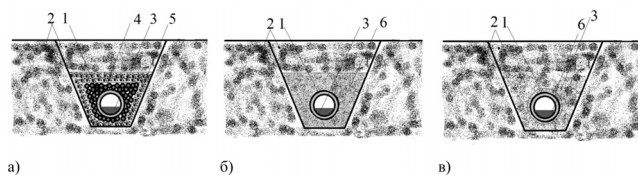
Конструкции дренажа: а – многослойная обратная обсыпка; б – однослойная обсыпка мелким песком; в – труба с защитной оболочкой, 1 – дренажная труба, 2 – местный грунт, 3 – вода в дренажной трубе, 4 – щебень или гравий, 5 – крупный песок, 6 – мелкий песок.
